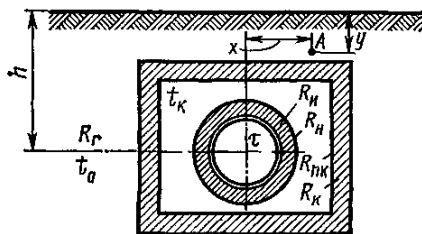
Расчетная схема однотрубного теплопровода канальной прокладки
